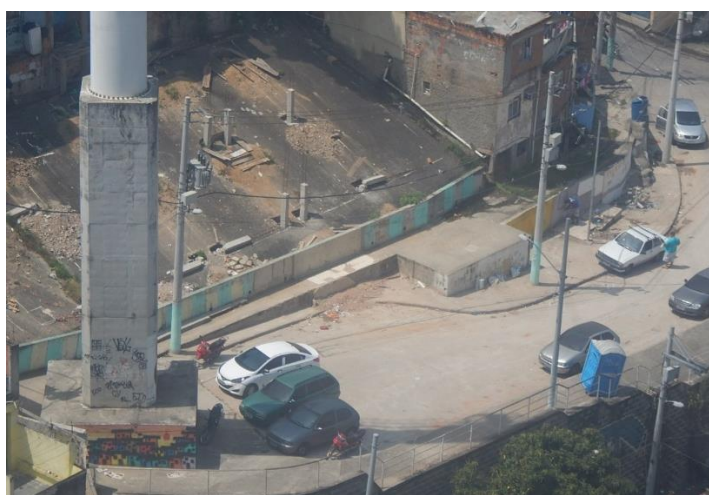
Pilares e excavaciones abandonadas en el talud.
